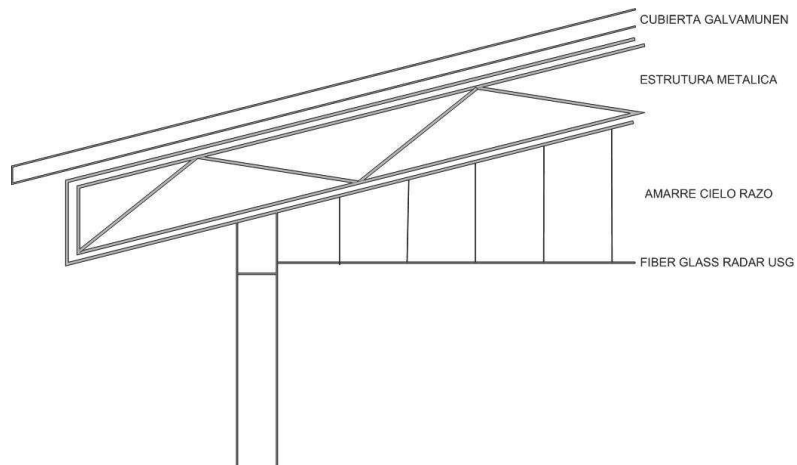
Detalle de Cubierta y cielo raso falso.
